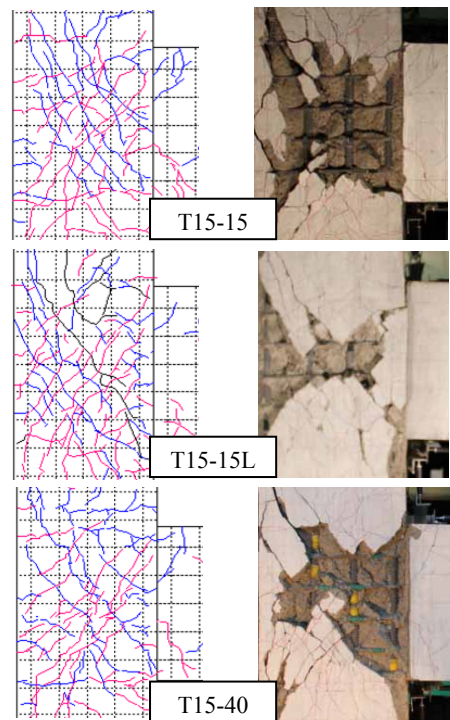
$R=1/50\text{rad}$ . 時 写真-1 最終破壊状況 ひび割れ状況
